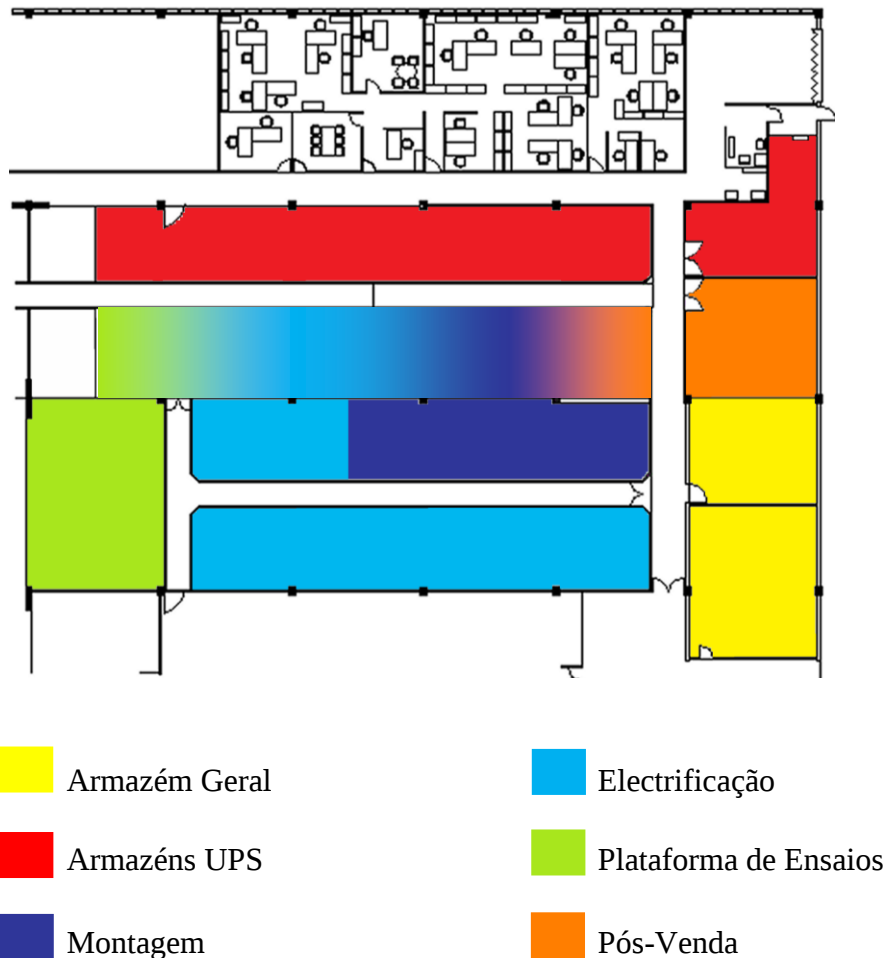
Planta do SA com as áreas demarcadas e legendadas
